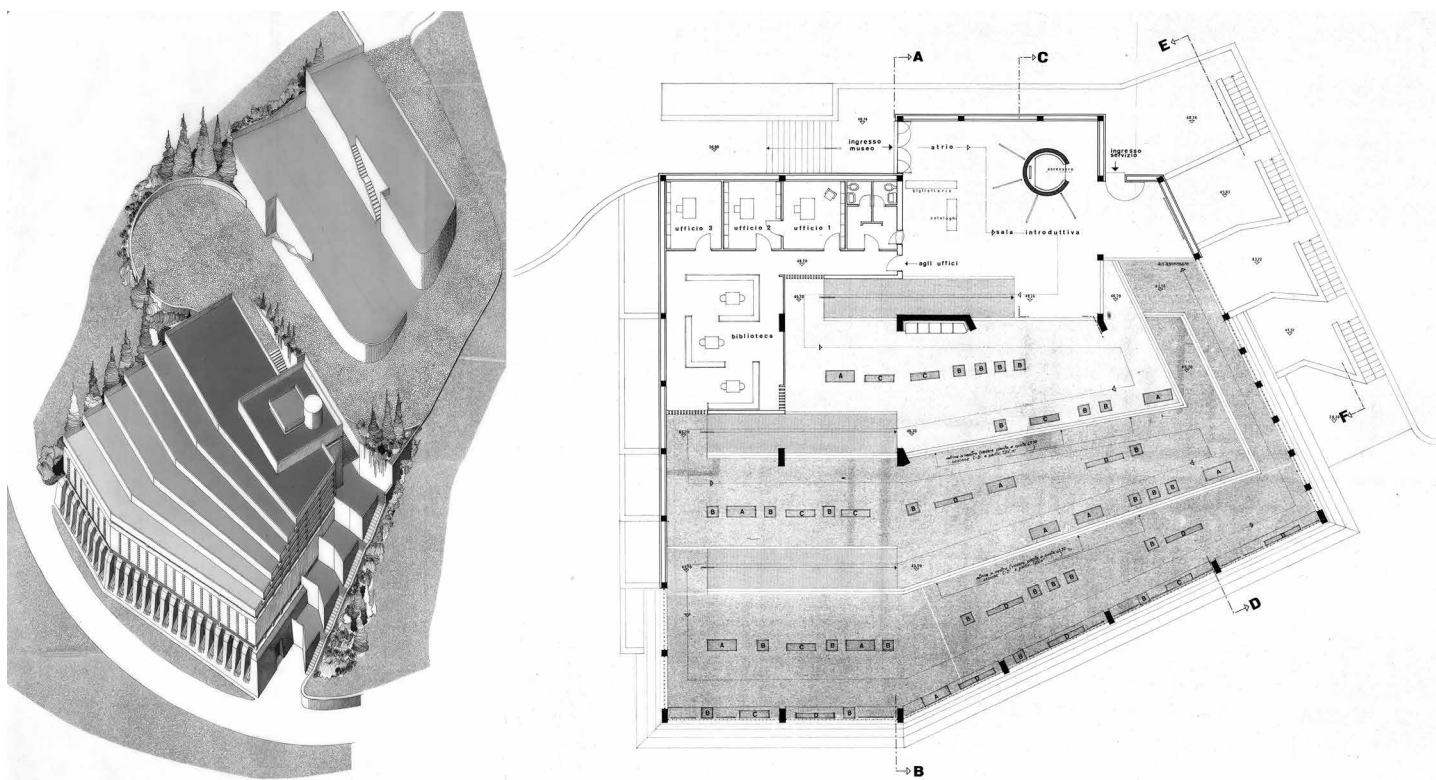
F. Minissi, *Progetto dell'antiquarium di Himera a Termini Imerese*. Vista assonometrica e pianta a quota +48,20 (Collezione privata, Palermo).
